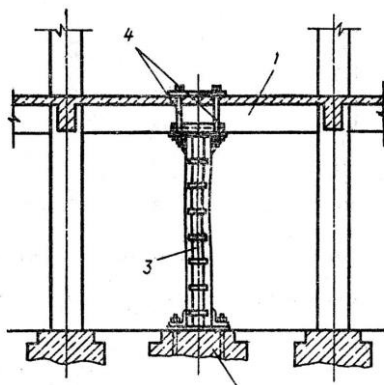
Усиление балки подведением жесткой опоры: 1- усиливаемая балка; 2 – дополнительный фундамент; 3 – колонна усиления; 4-болты
